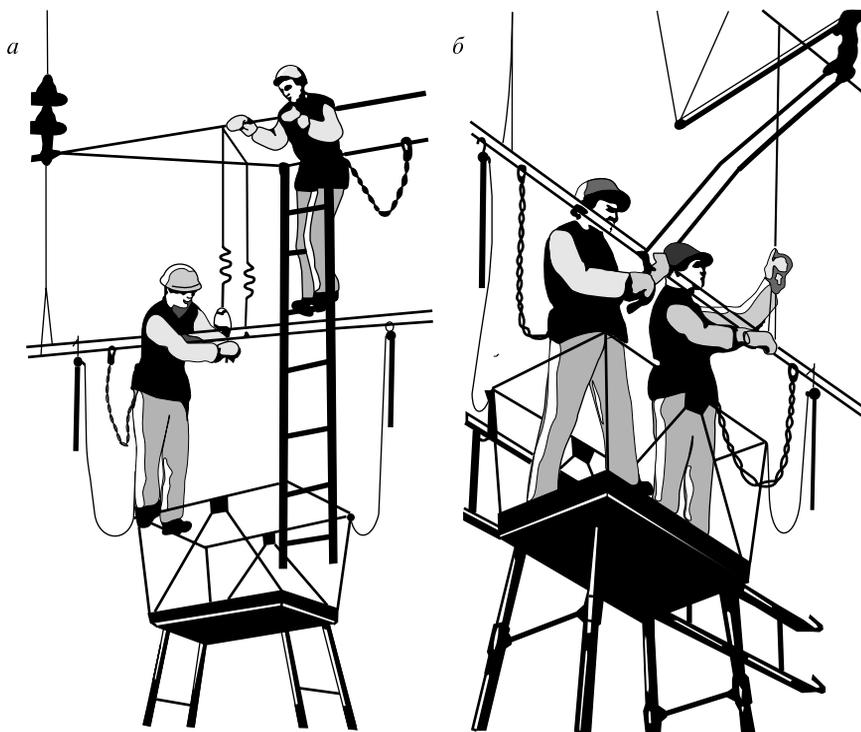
Работа на контактной сети под напряжением: *а* — на несущем тросе с использованием 3-метровой лестницы; *б* — на контактном проводе
